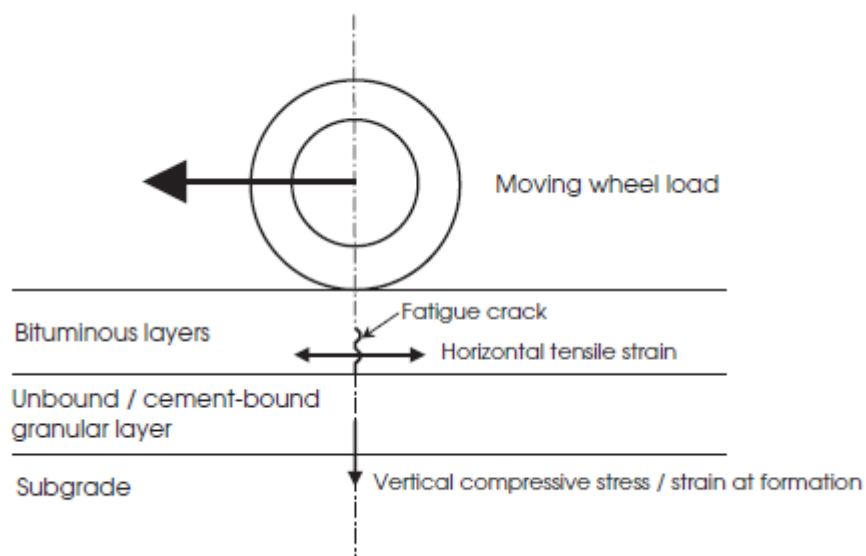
Tensiones críticas en una losa de pavimento de carretera bituminosa.
